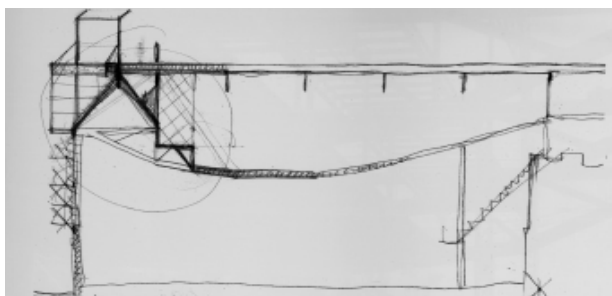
Croquis de Sota de la sección transversal ya con la estructura de cerchas de perfil quebrado con el desarrollo del lucernario y frente acristalado en la fachada.
